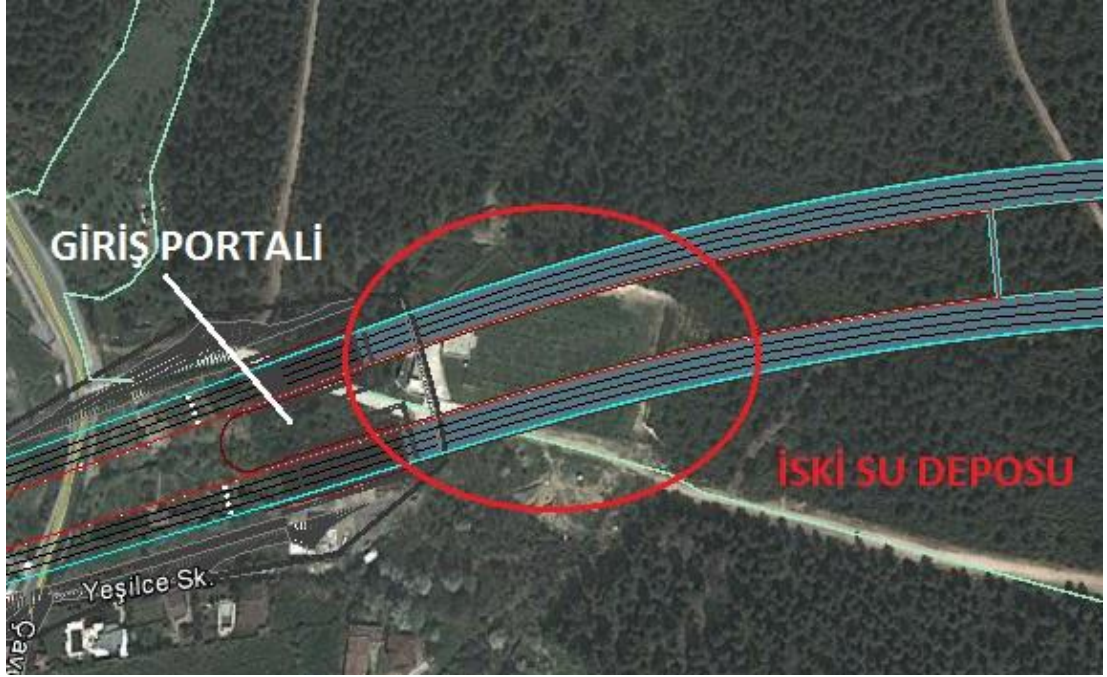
Çamlık Tüneli genel yerleşim planı.
